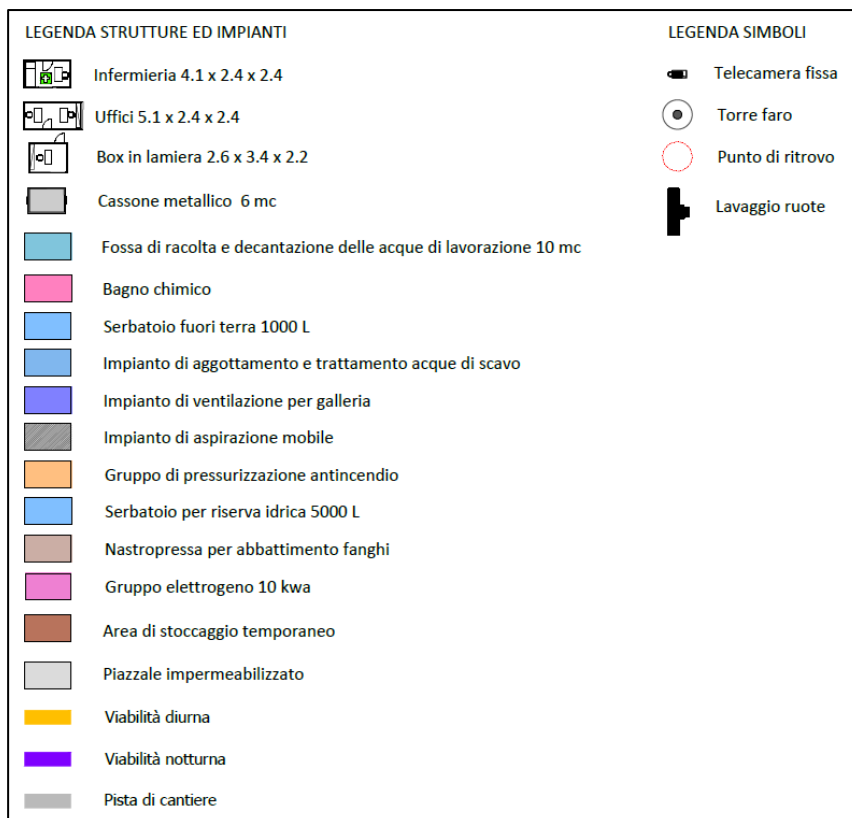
Legenda layout del cantiere operativo all'imbocco nord (CO 02)
